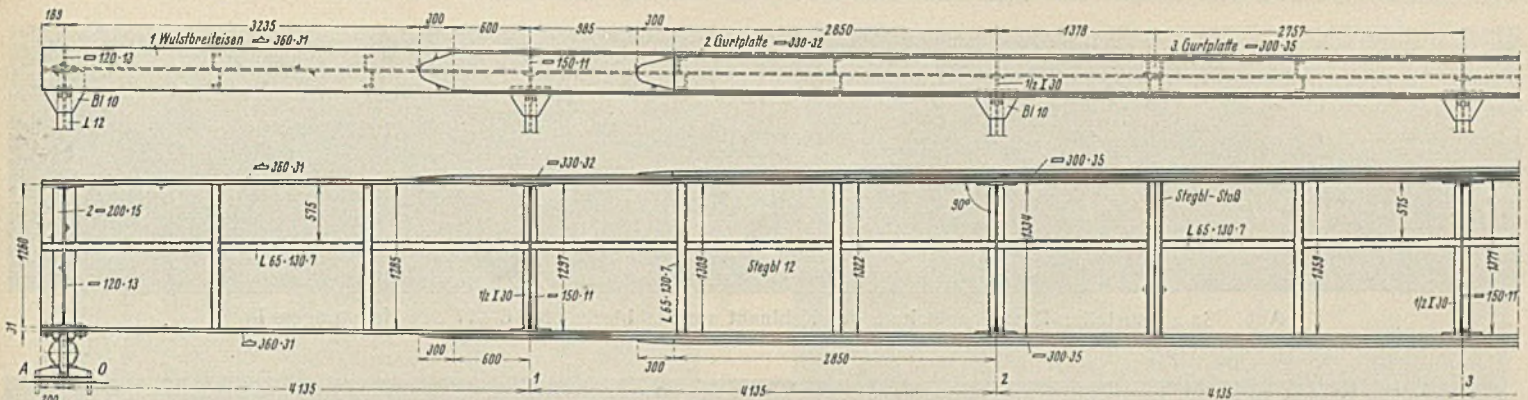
Geschweißter Hauptträger (0-3 in Abschn. A-D) mit Querschnitt der Schweißkonstruktion.
